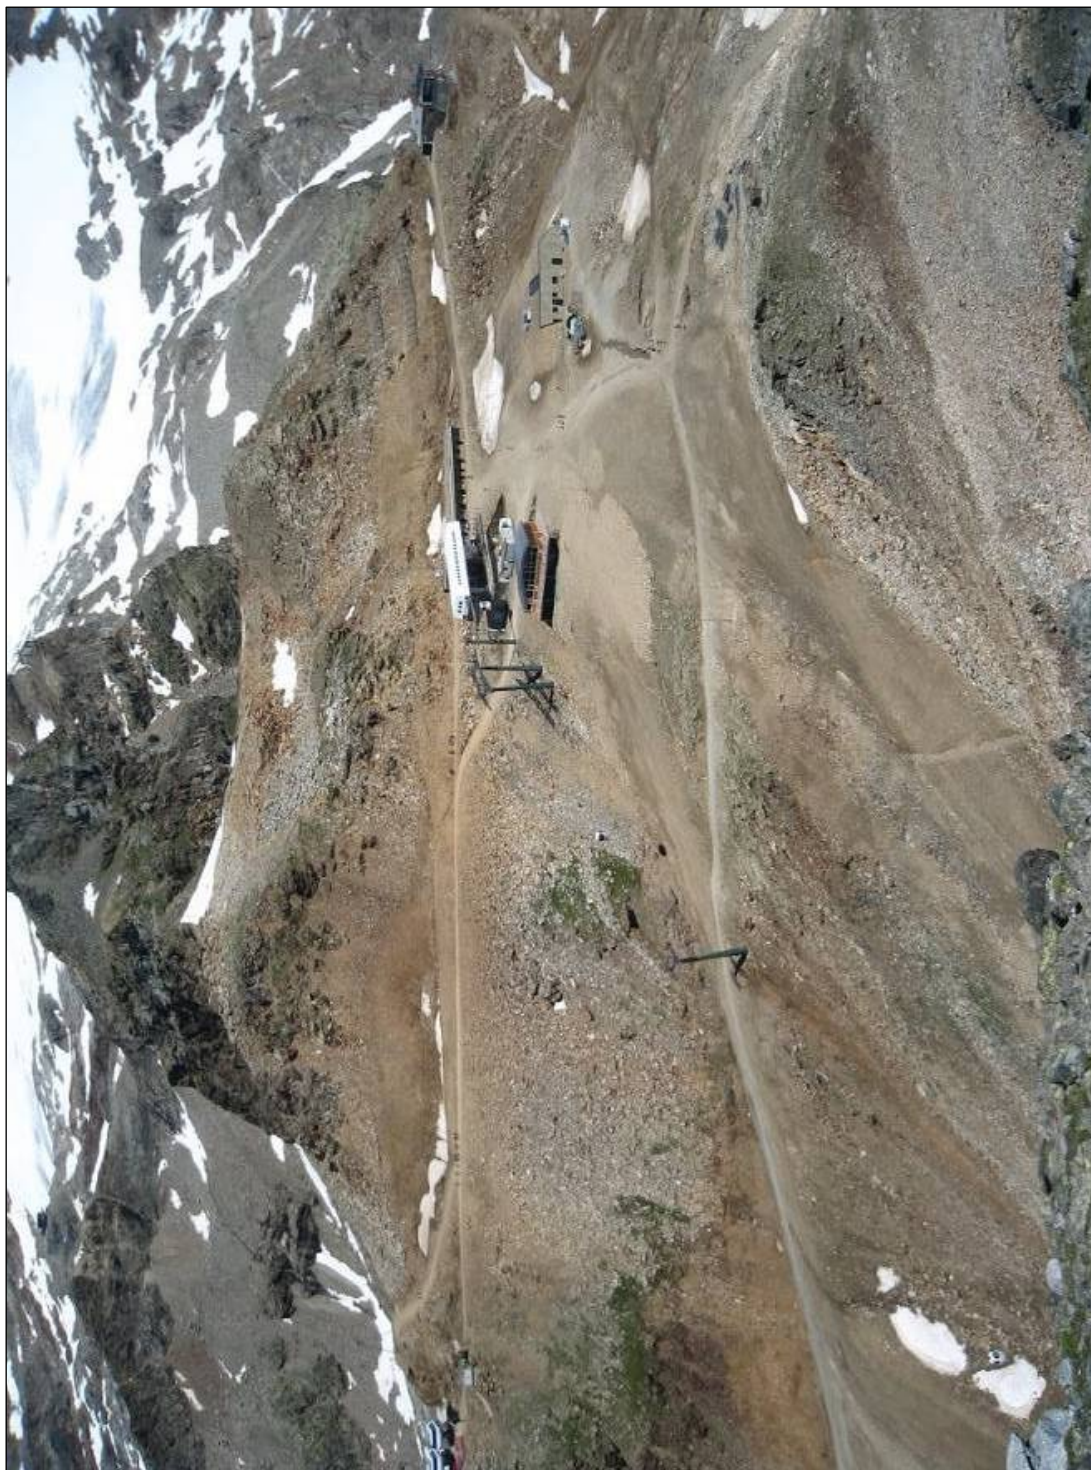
/5 Fotoinserimento della stazione di monte - Panoramica dal Corno Rosso – Stato attuale
